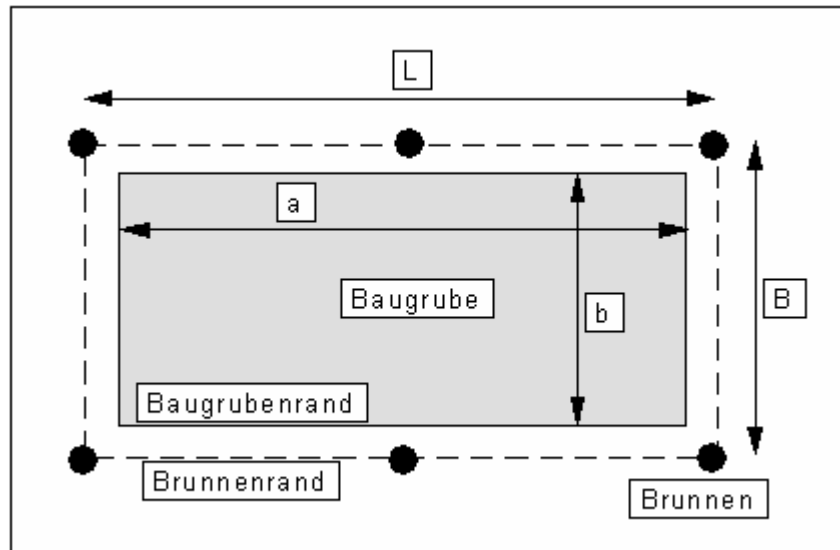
Bezeichnungen (Grundriss)
